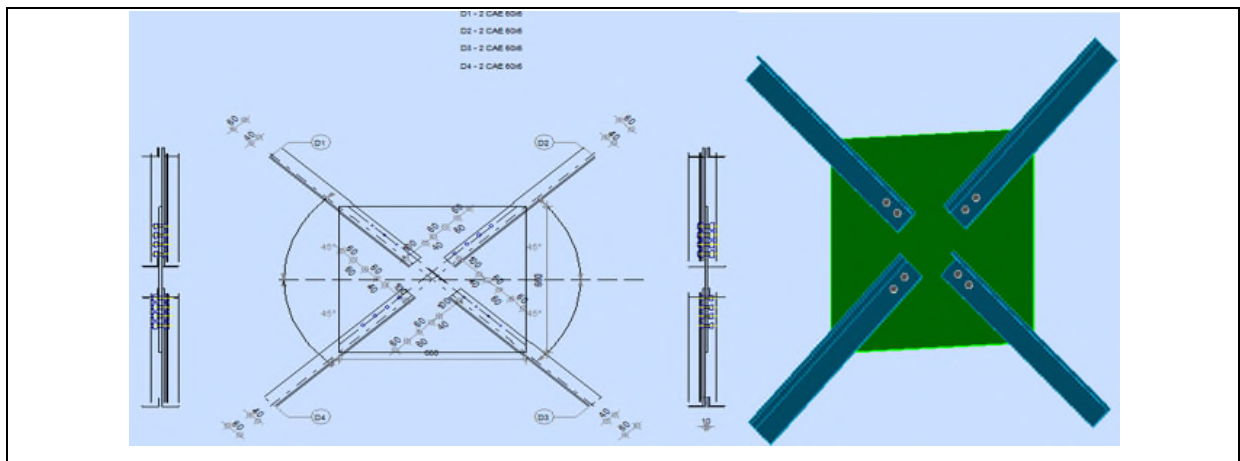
Représentation de l'assemblage poutre au vent.
